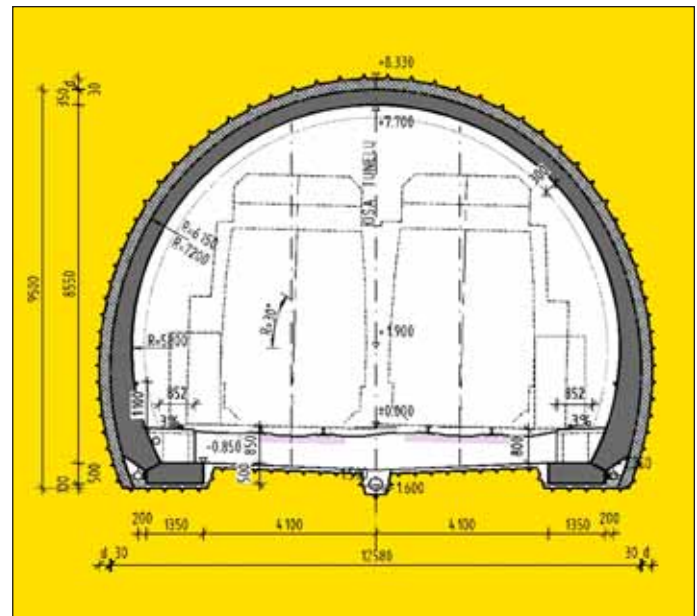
Vzorový příčný řez dvokolejným tunelem se spodní klenbou
